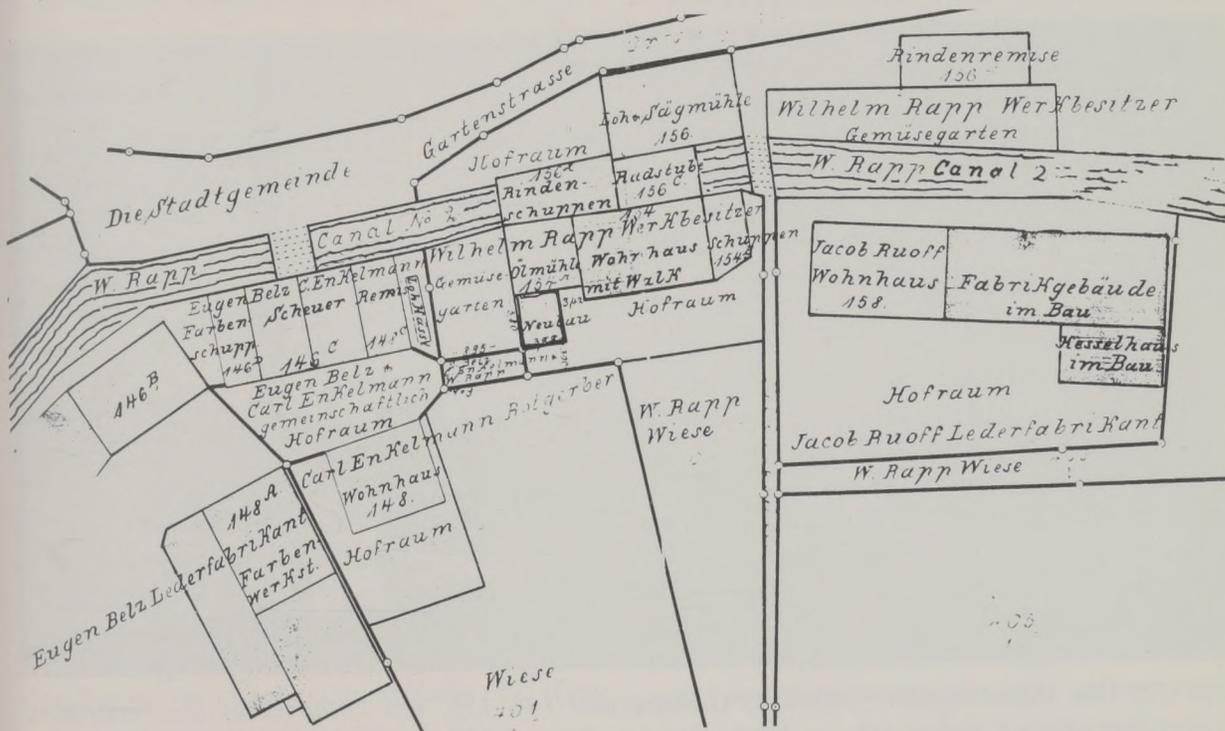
Lageplan vom Industriebereich „Walke“ im Jahr 1898.
